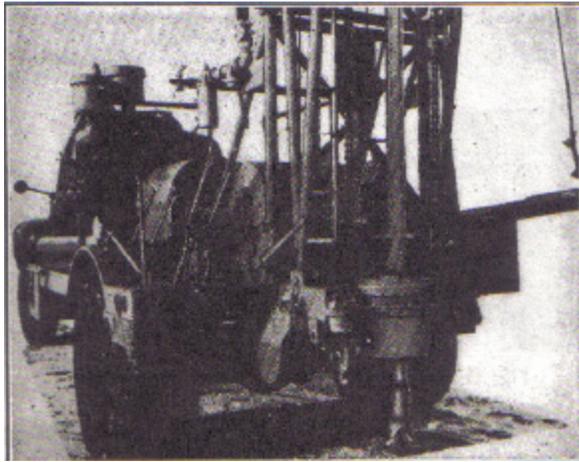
Barreno barrenador (Davey Compresor Co.)⁽⁶⁾
